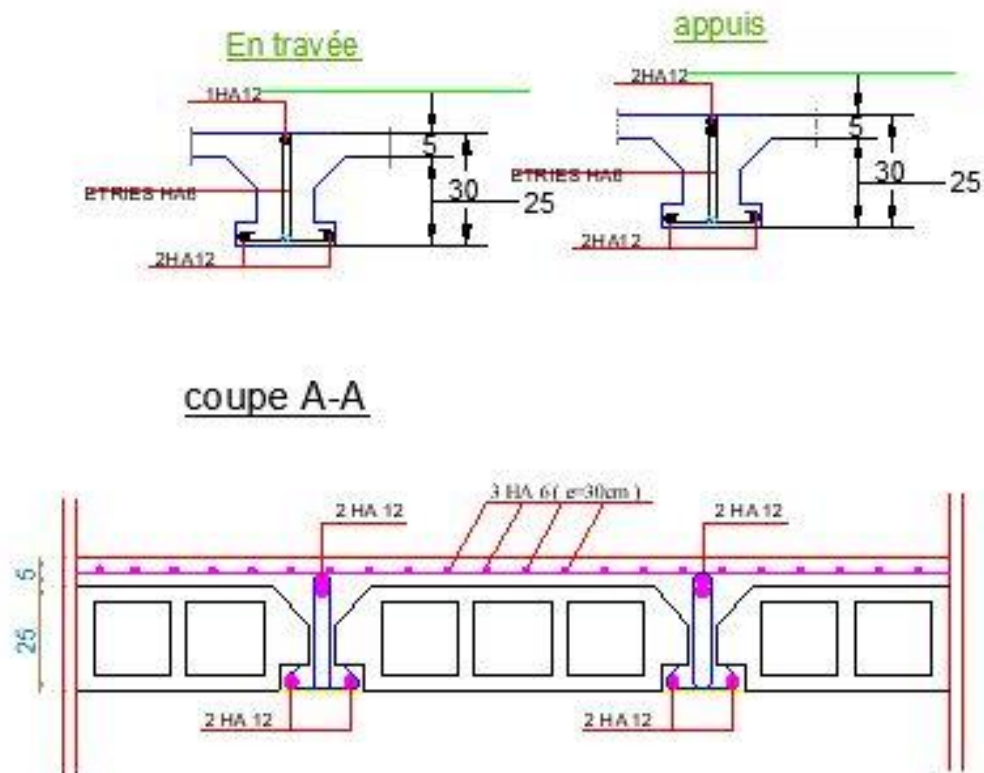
Schéma du ferrailage des poutrelles et dalle de compression.
